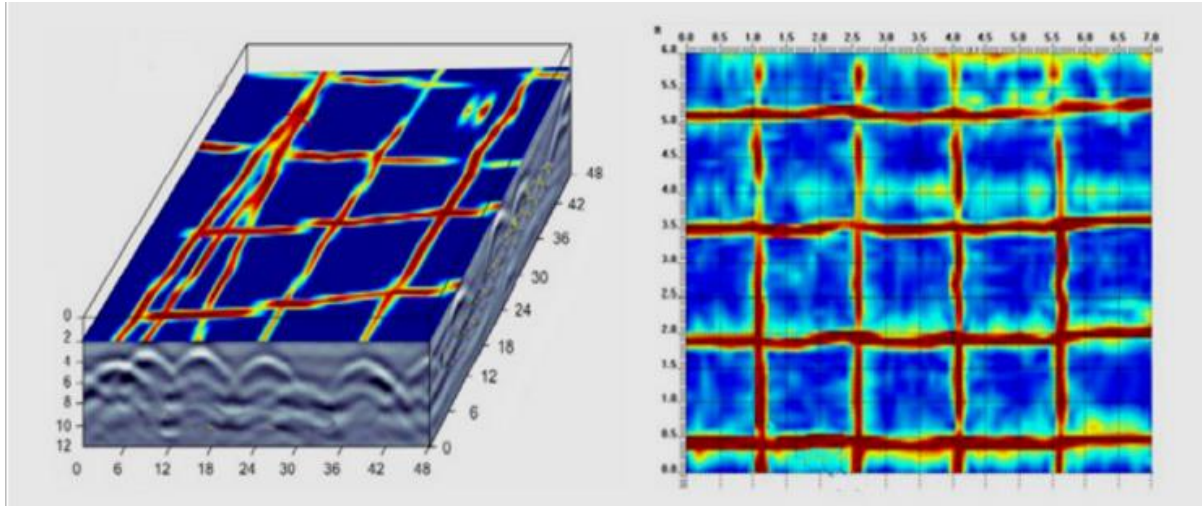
Imágenes resultados Georadar en Hormigón Armado
